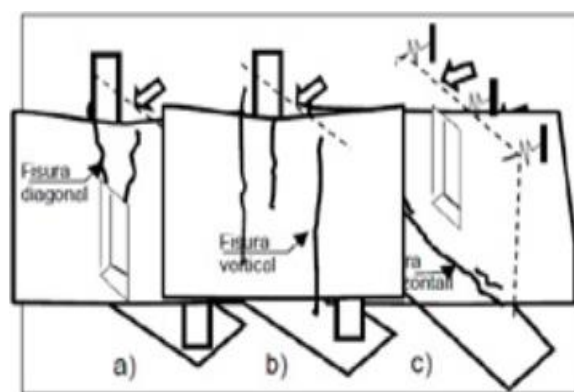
Tipos de fisuras en muros de adobe.
